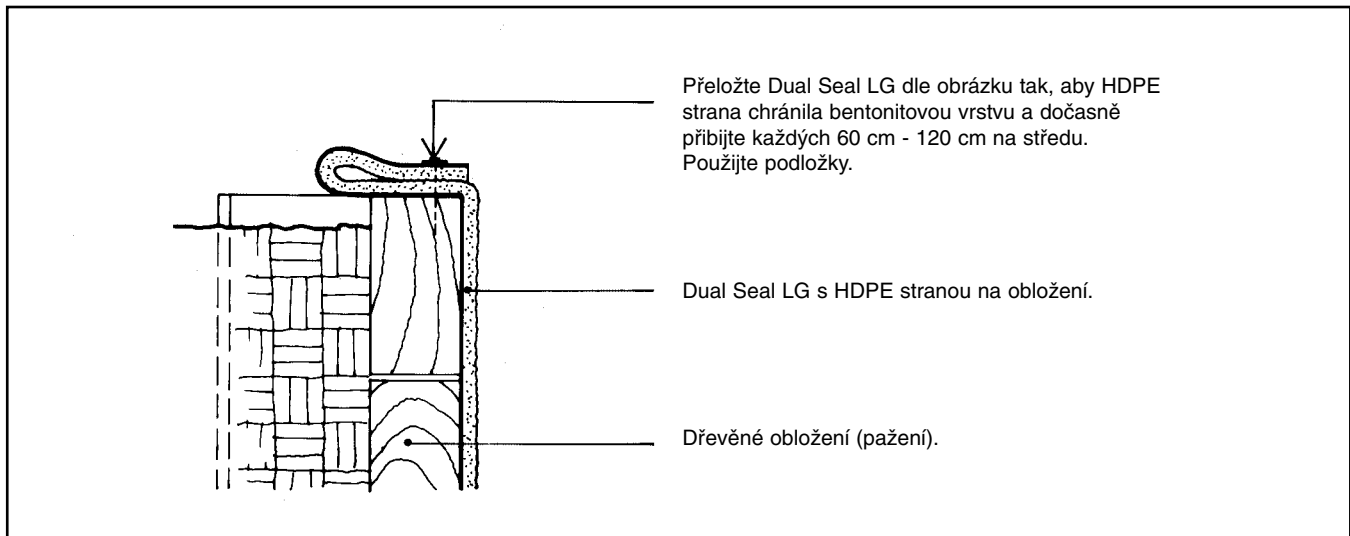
Instalace Dual Seal LG na vodorovné nechráněné zdi k výplňovým přechodkům.
